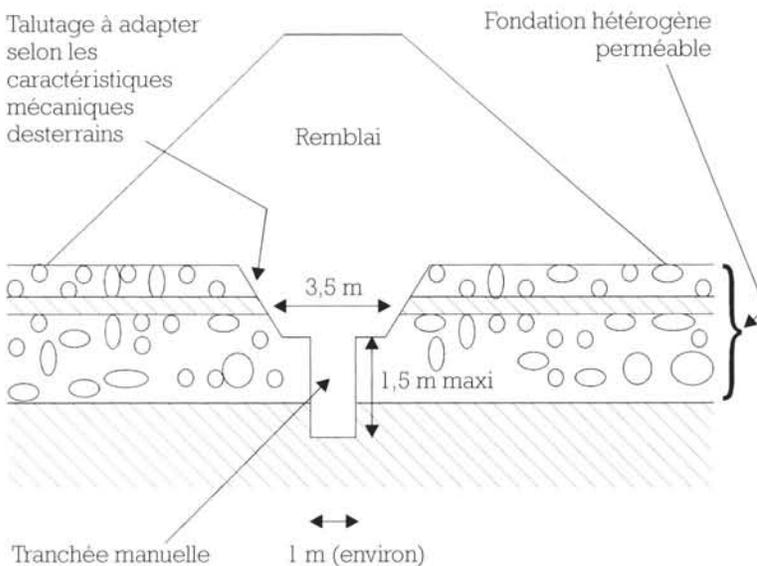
Clé d'étanchéité avec pré-tranchée.
